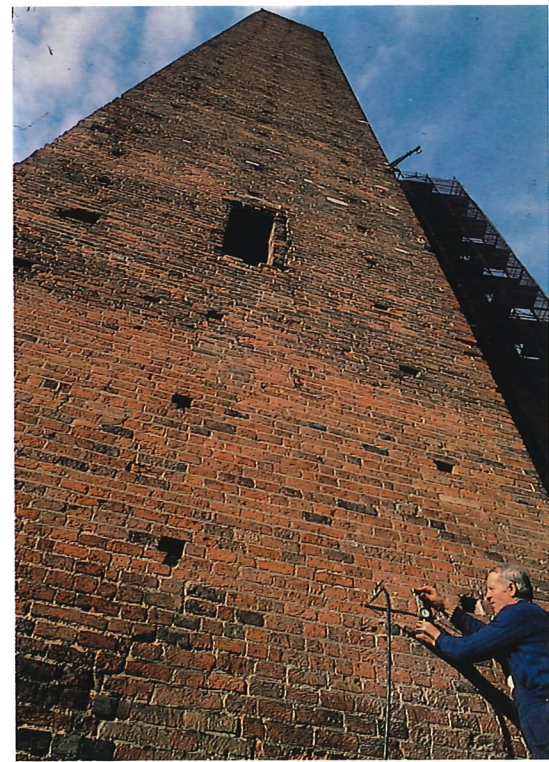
Pavia, Torre medieval. Gatos planos aplicados para la medida del estado tensional.
